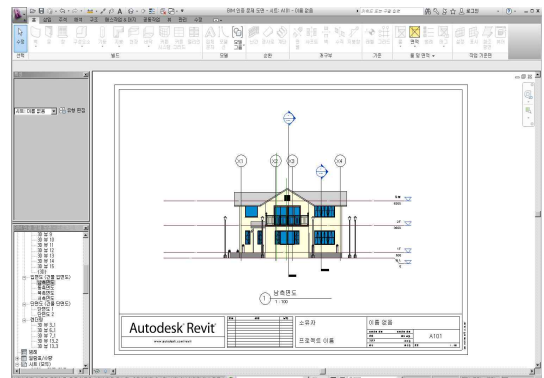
모범답안 사례-남측입면도 Sheet 삽입
